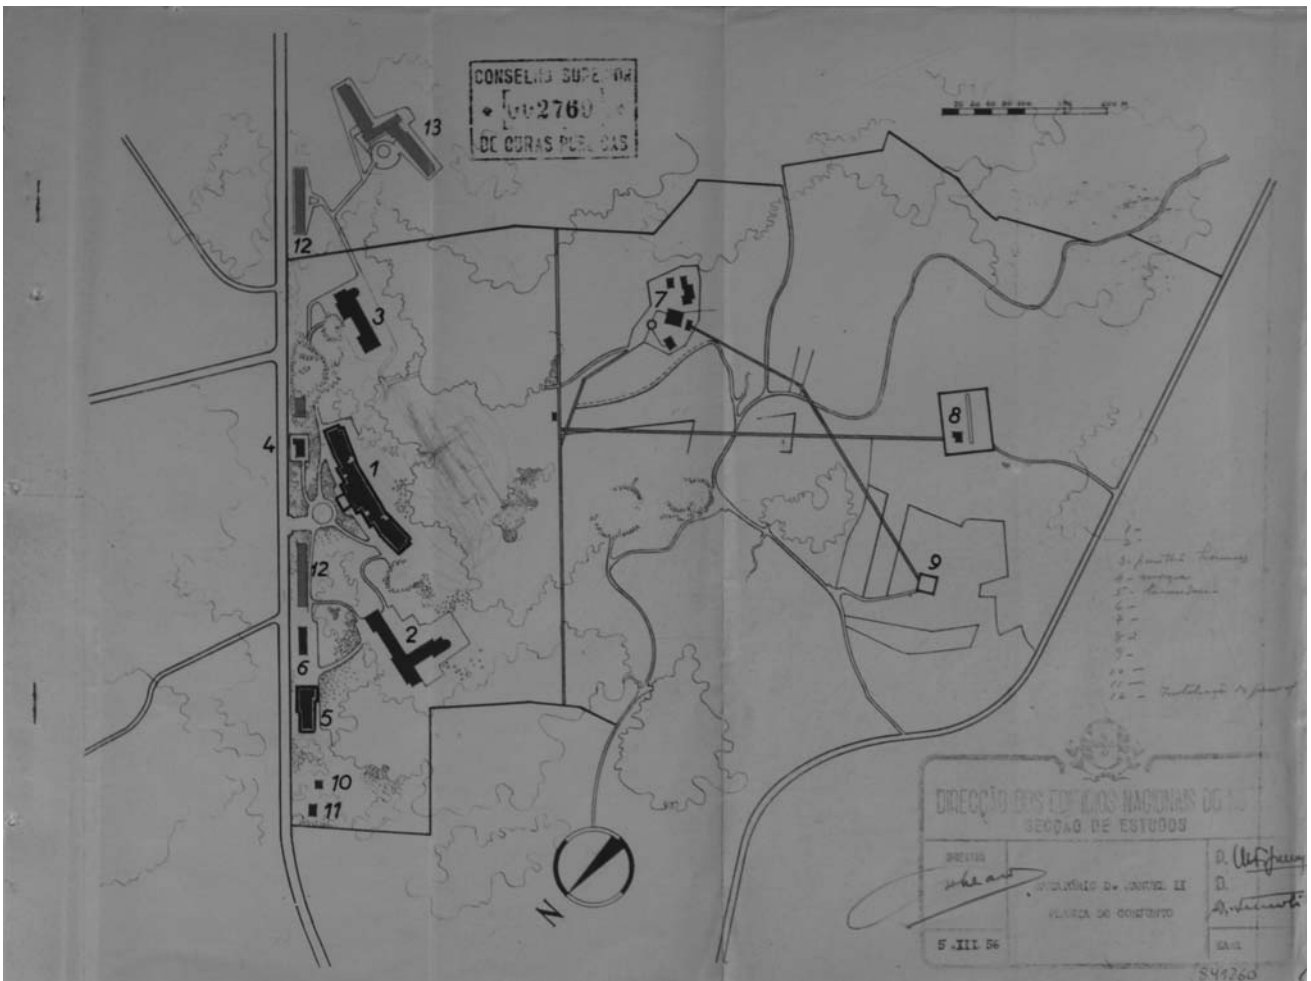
Planta de Conjunto. [autor ilegível]. 1956.12.05(m.). SIPA: DES\_841260.
